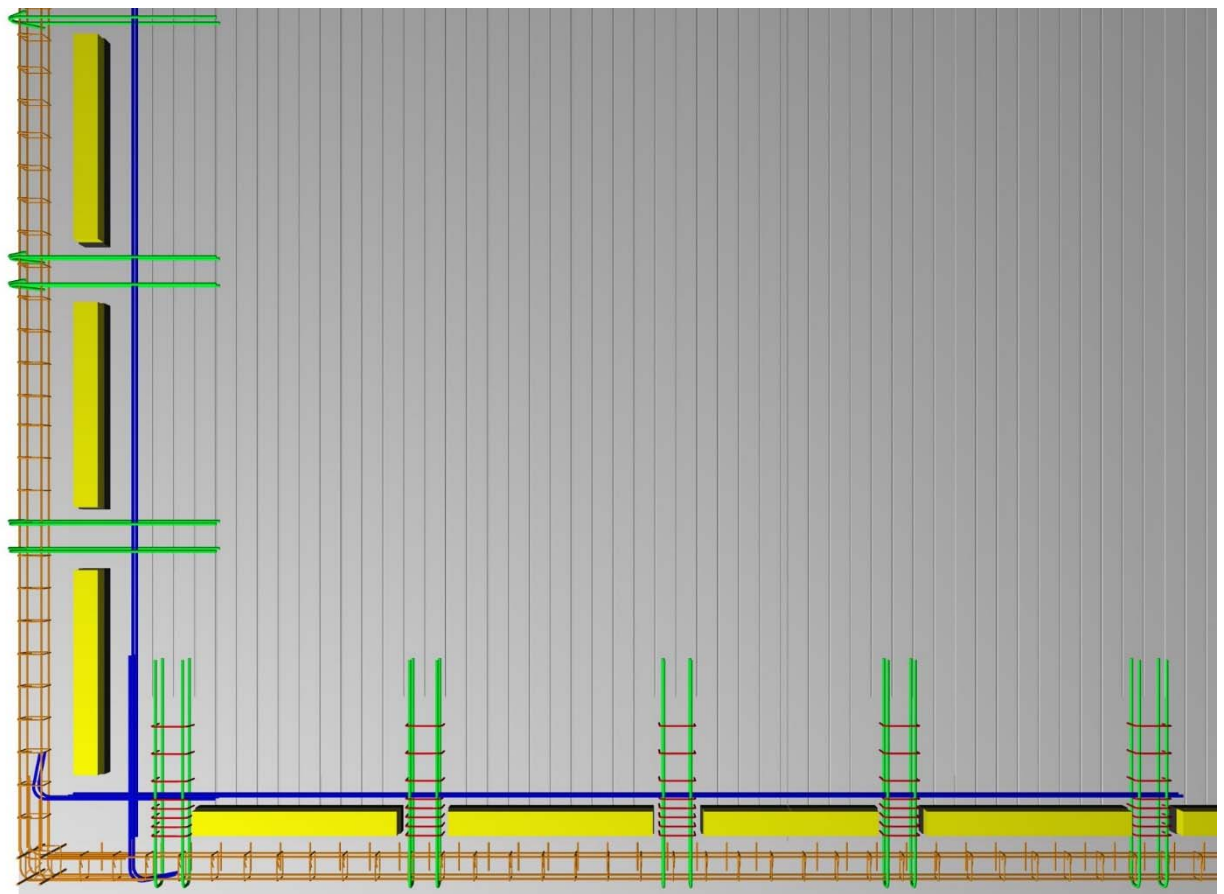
Cas de la prédalle de rive - Vue en plan – Coffrage
